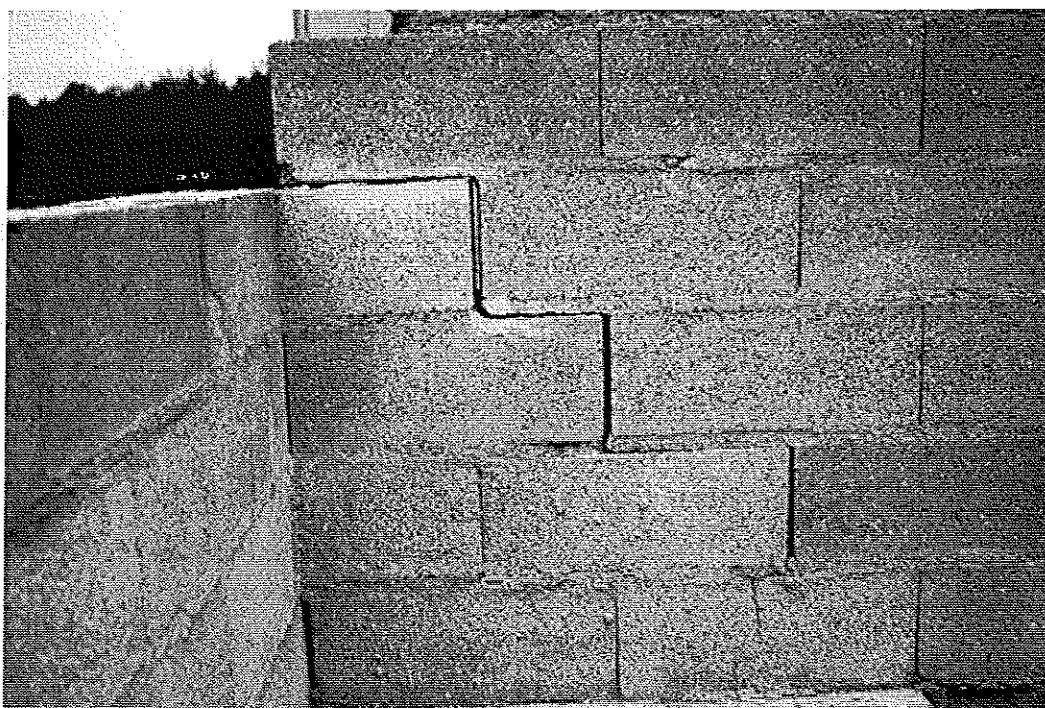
Accentuation de l'ouverture de fissure en escalier en partie haute avec retour sur joint horizontal. Joints verticaux *non hourdés*. Absence de harpage avec blocs allège, fissures traversantes.
